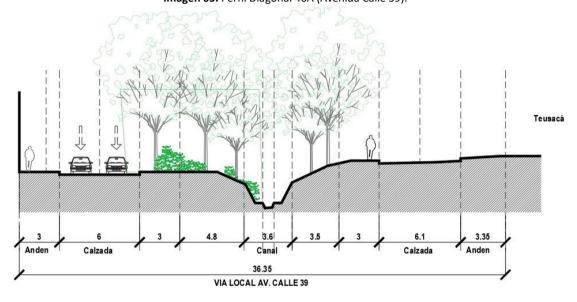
Perfil Diagonal 40A (Avenida Calle 39).
